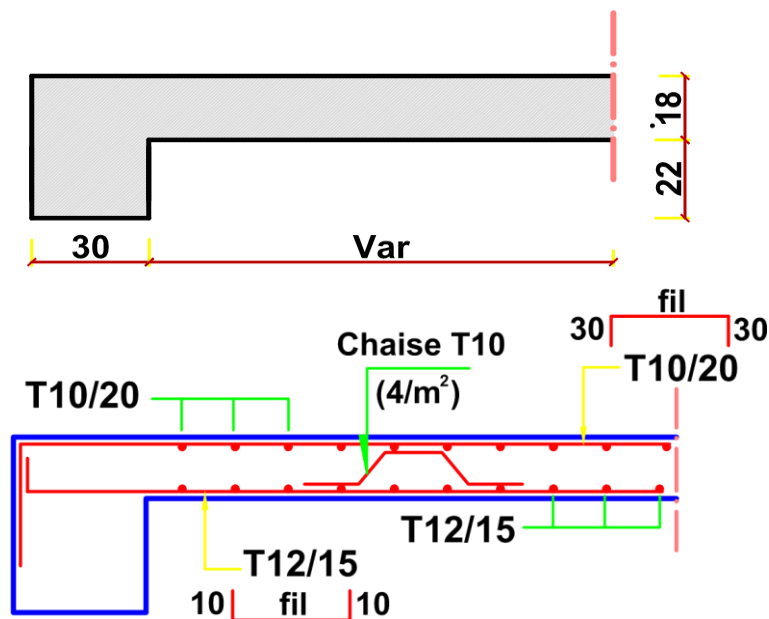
Schéma de coffrage et ferrailage du plancher à dalle pleine (Sous-Sol)
